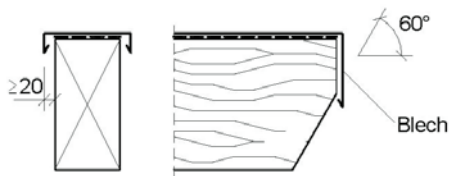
Holzträger mit Blechabdeckung, Quer- und Längsschnitt. Die seitlichen Überstände sollten mindestens 20 mm betragen. Bei Durchdringungen mit Schrauben ist eine Abdichtung einzubauen.
